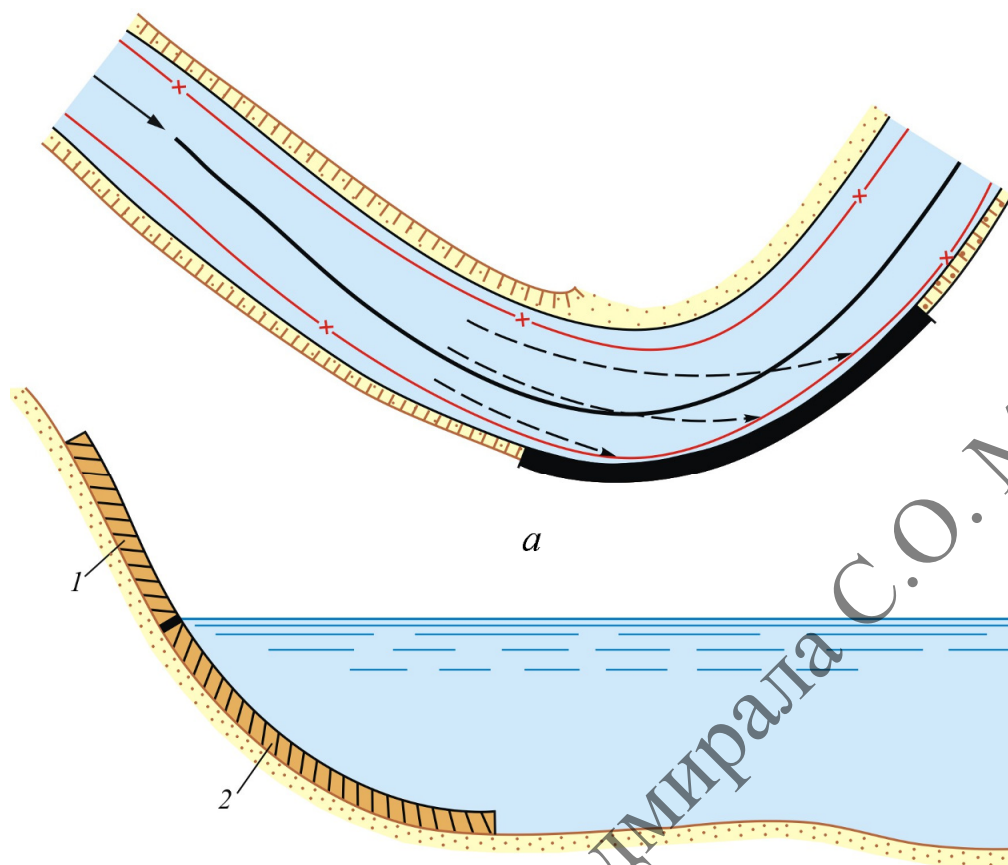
Береговое укрепление. *а* — план; *б* — поперечный разрез.
